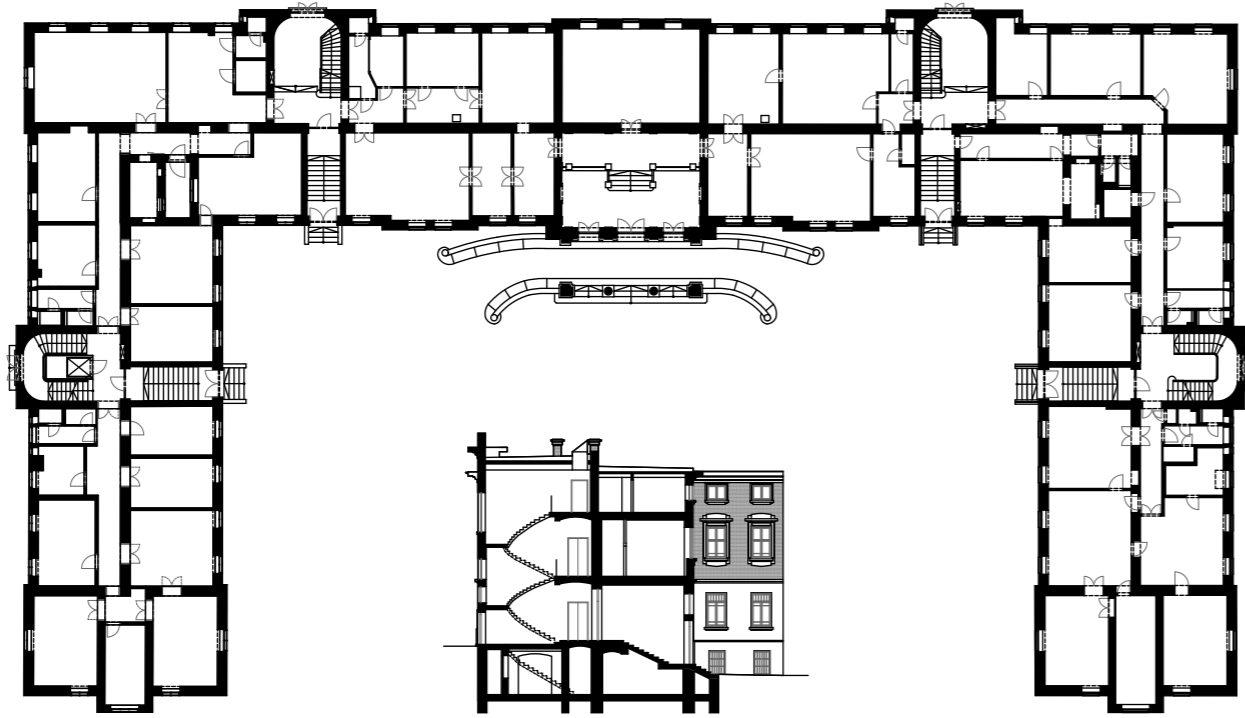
Bestandsplan Administrationsgebäude | Erdgeschoss - Schnitt | M 1-500
